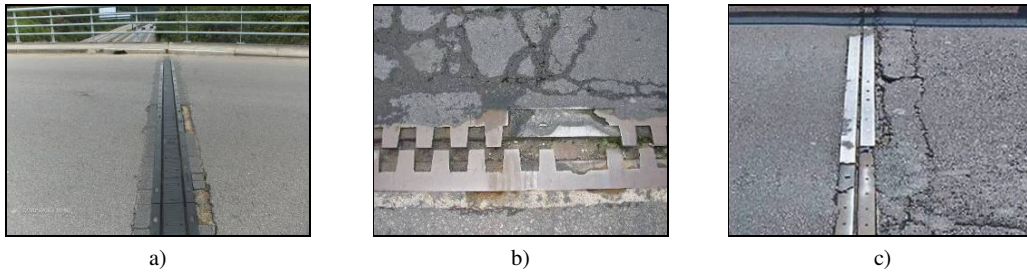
Exemplos de patologias em junta de dilatação: a) Deterioração da banda de transição; b) Ausência de pares da junta metálica; c) Deterioração do pavimento
